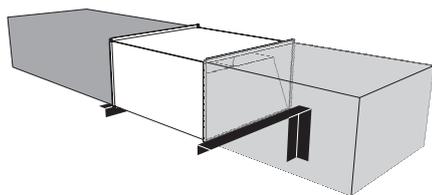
Installation au mur, au sol ou au plafond
